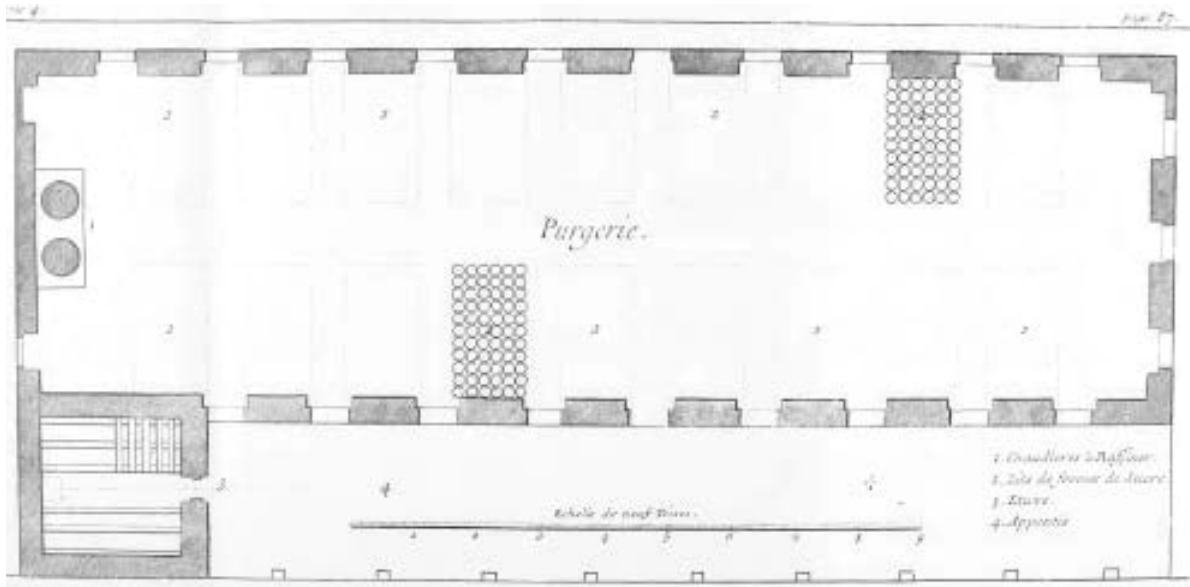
Planta de la casa de purga (Labat 1742b: 87).
